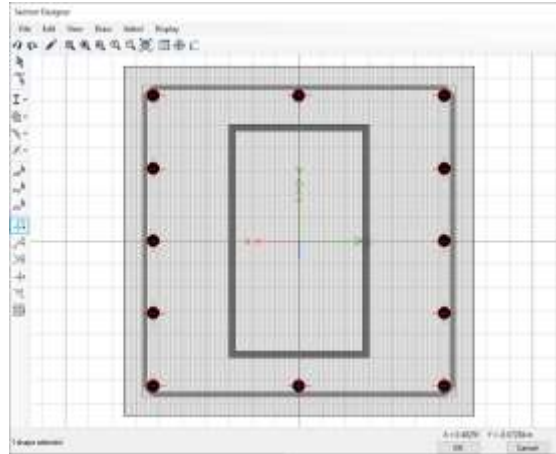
Definición de columna de 75x75 reforzada con perfil metálico tubular cuadrado
